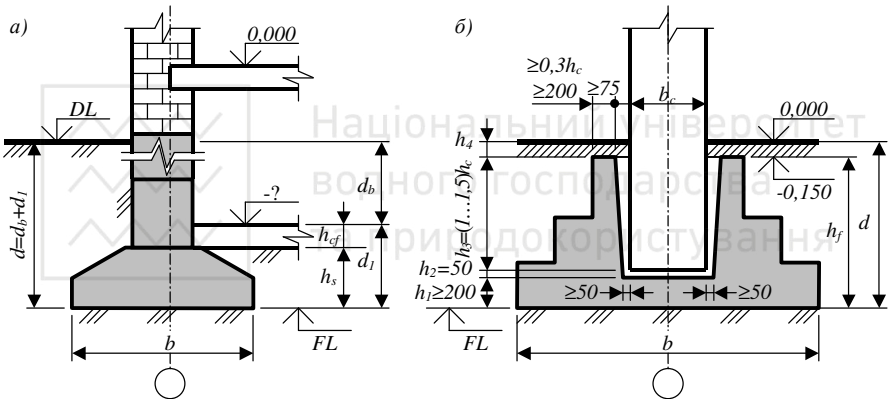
Схема до визначення глибини закладання фундаментів мілкого закладання залежно від конструктивних особливостей: *a* - для стрічкового фундаменту під стіну будівлі з підвалом; *б* - для стовпчастого фундаменту під збірну залізобетонну колону будівлі без підвалу; *DL* - позначка поверхні спланованого рельєфу; *FL* - позначка підшови фундаменту; b_c і h_c - розміри поперечного перерізу колони
